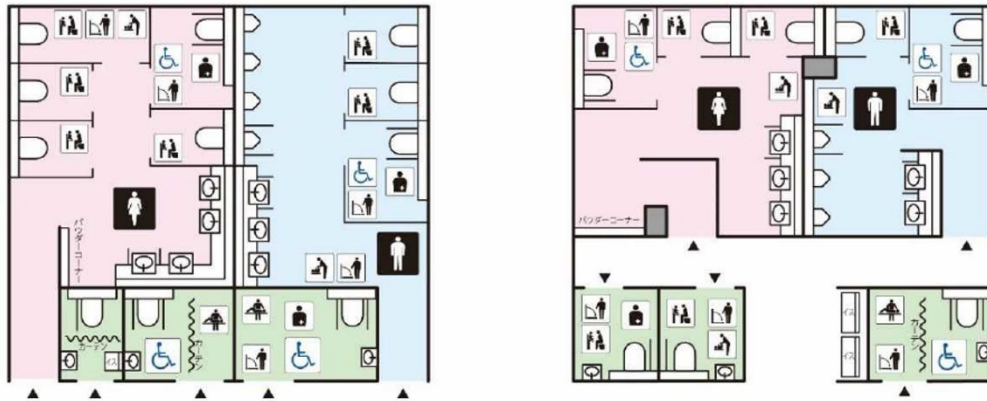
Exemple de plans pour l'installation de lave-mains
